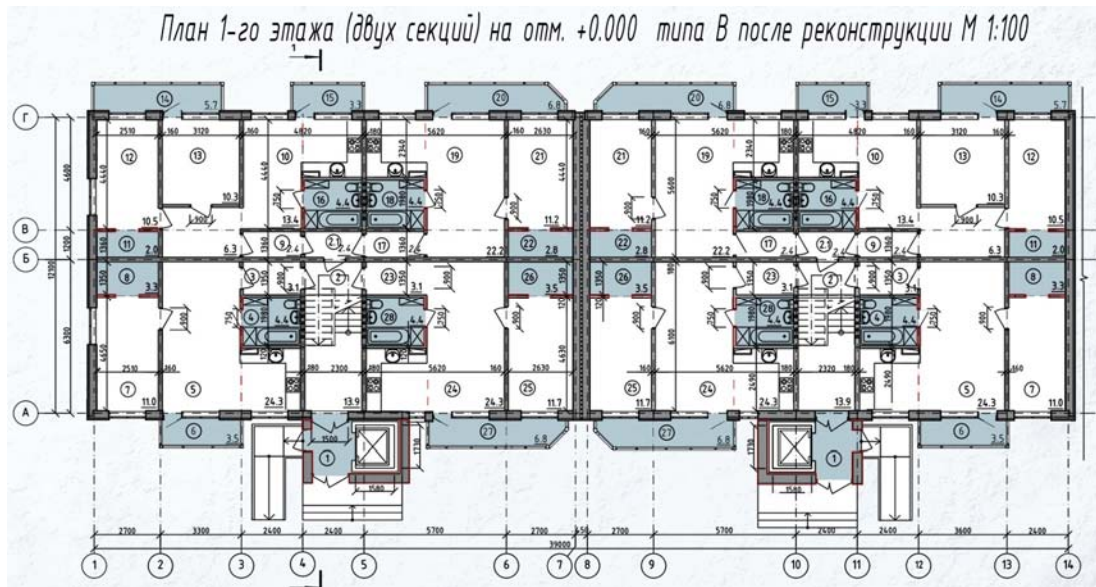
Экспериментальный проект архитектурно-градостроительной реконструкции жилого квартала в городе Донецке – план 1-го этажа (тип В) (после реконструкции) с устройством пристраиваемых наружных лифтовых шахт и средств для передвижения маломобильных групп населения (пандусов) при входе в подъезд
